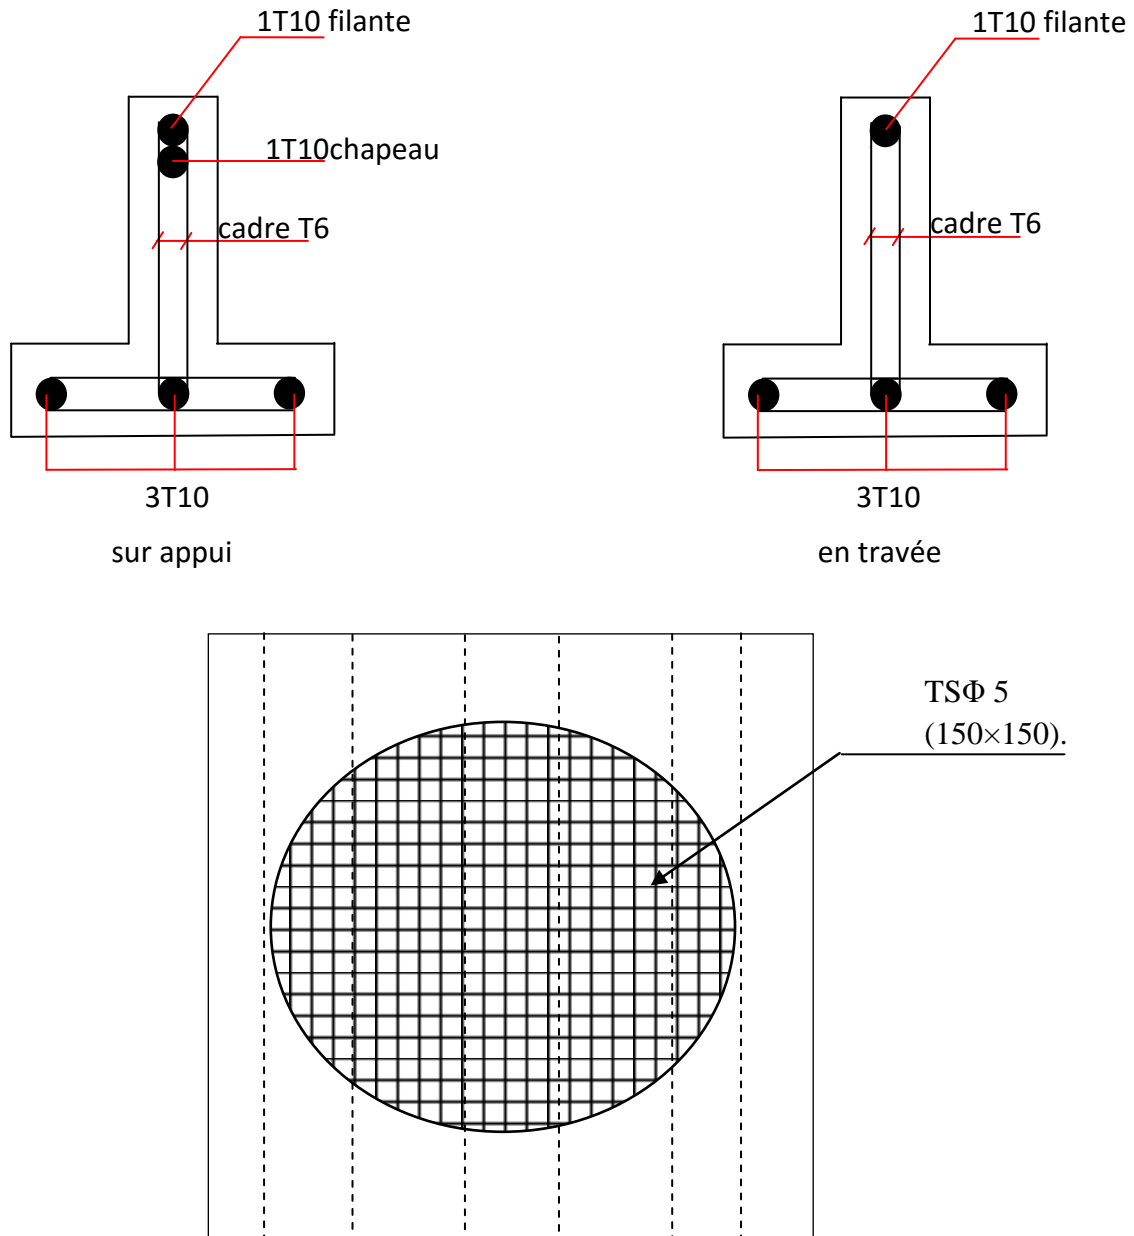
Schéma de ferrailages des poutrelles du plancher terrasse.
